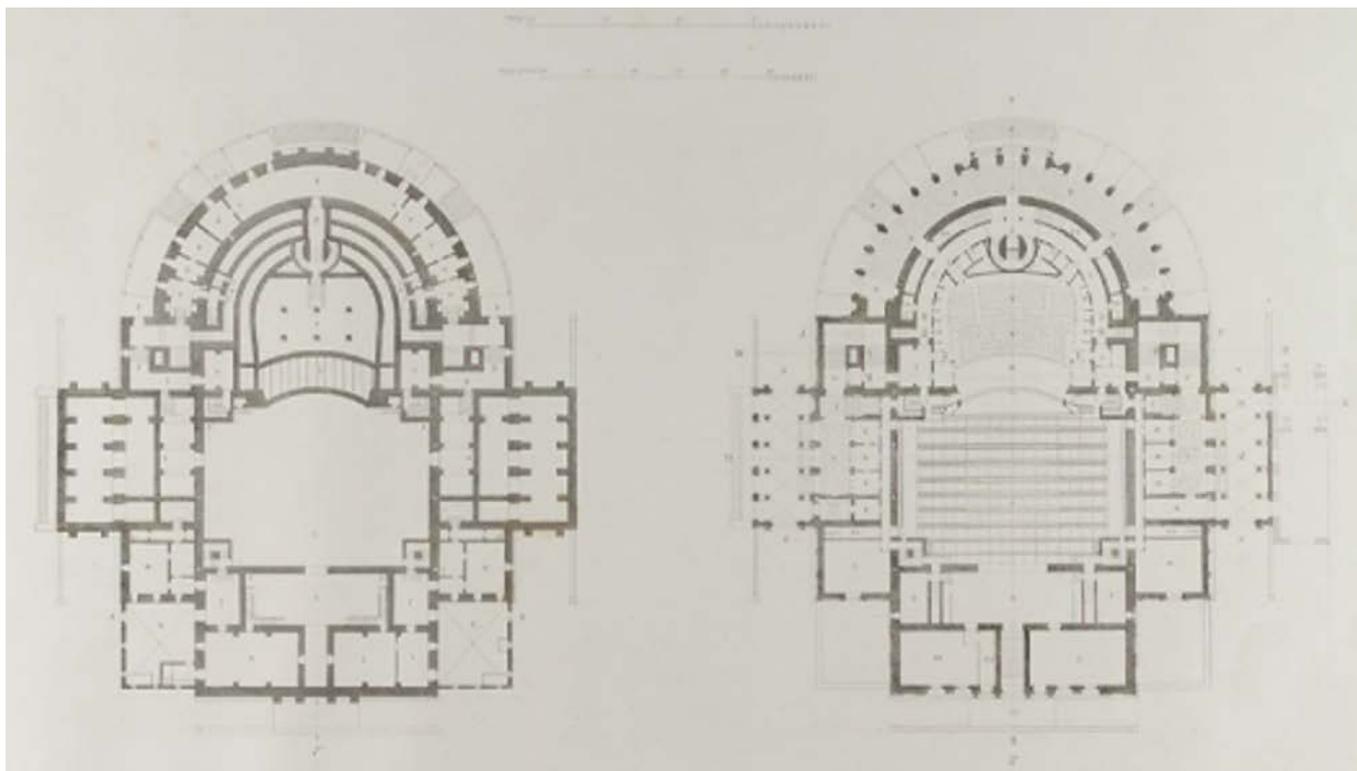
Planta baixa dos Recintos do Subsolo e do Andar Térreo
